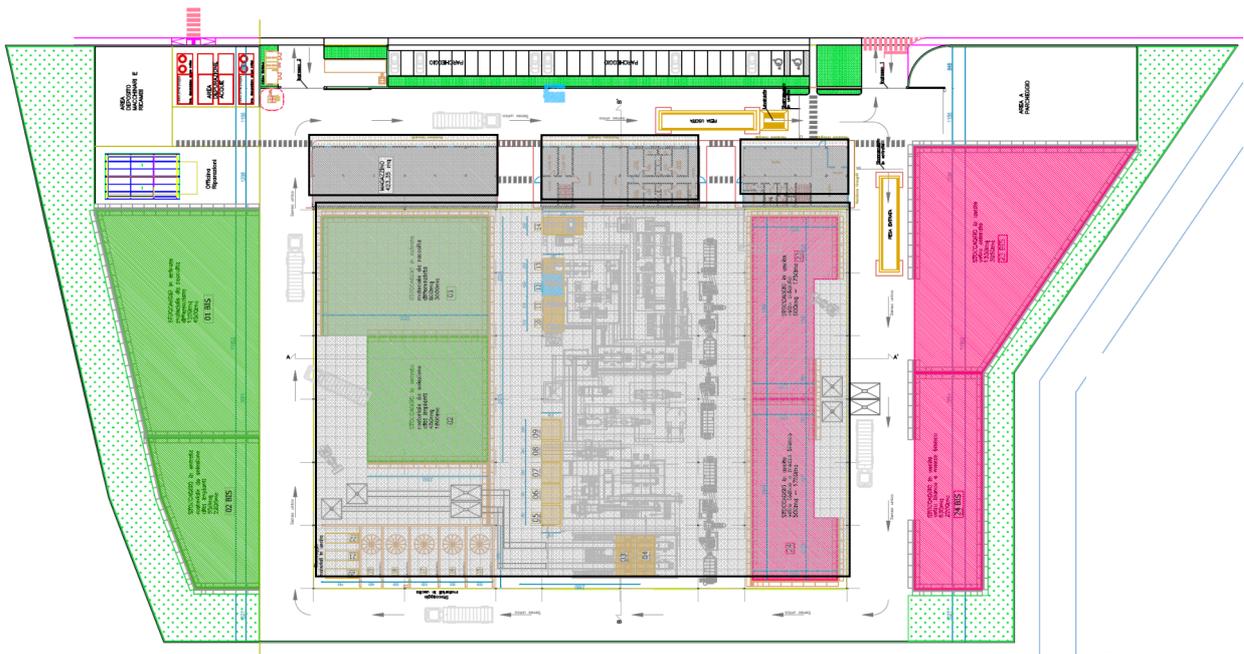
planimetria progetto trattamento rifiuti vetrosi assentito - 2014
